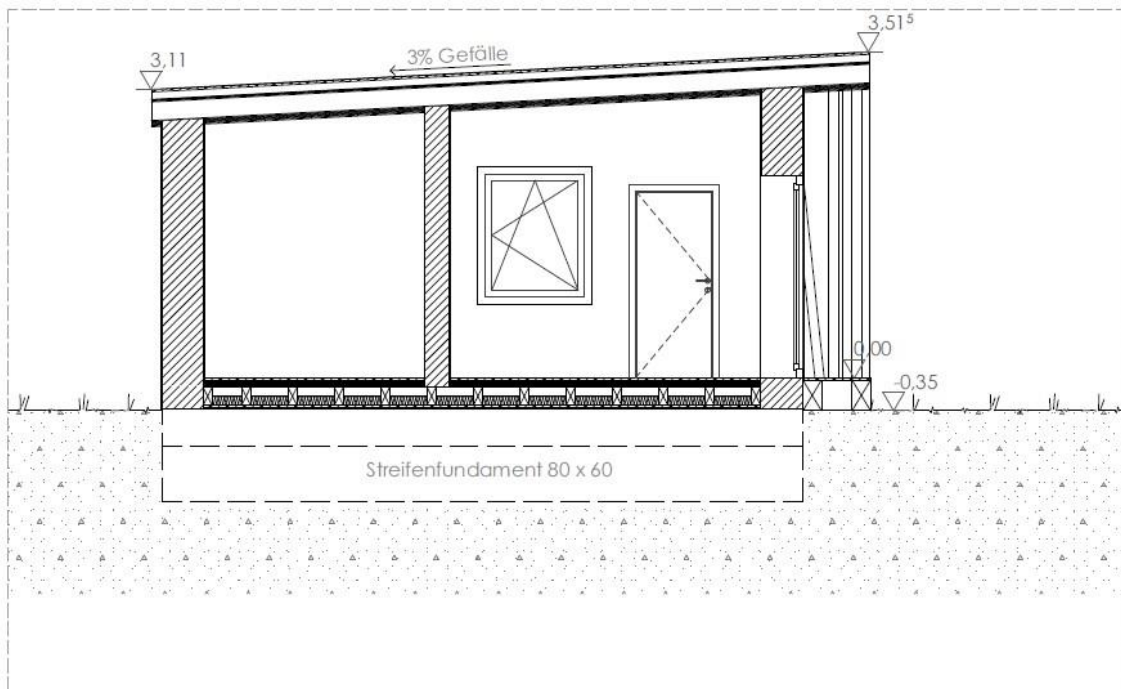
Baukonstruktiver Schnitt S01, M 1:100
